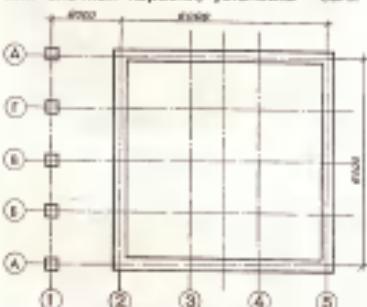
План фундамента. На оси А, Д, Е и Б — ленточный фундамент под кладку стен основного дома, на оси Г — столовый фундамент под террасу. Если брусья обивки достаточно мощные, то стены по осям Б и Г можно не делать или поставлять четырех столбов с интервалами по 2000 мм.
